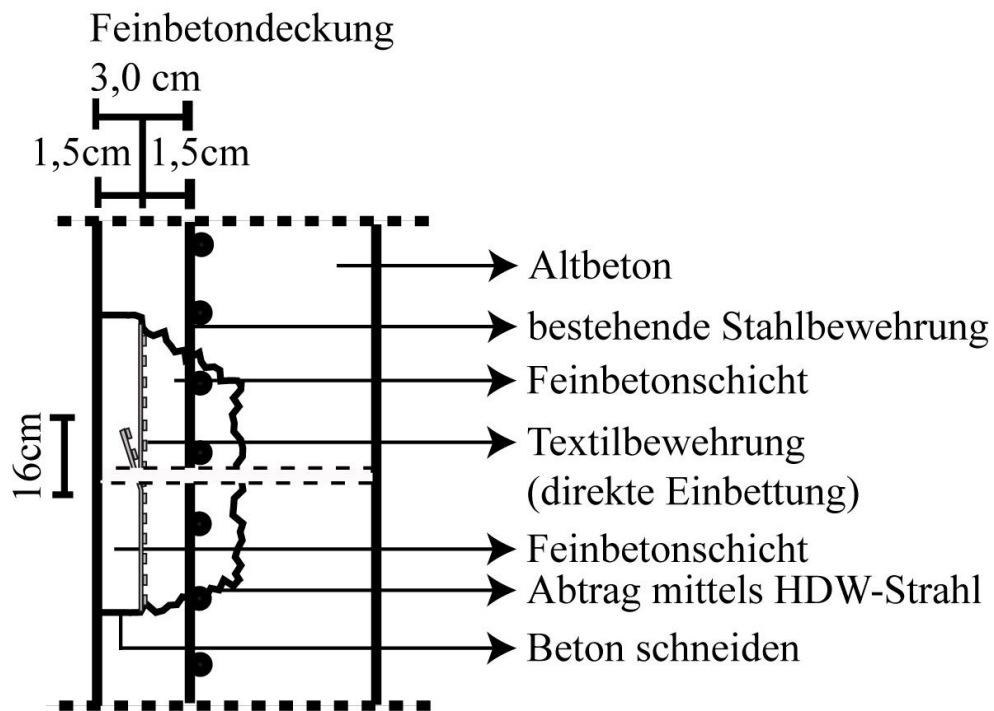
Prinzip einer Betoninstandsetzung mit Textilbeton und einer Lage Carbon-Textil solidian GRID Q85/85-CCE-21
